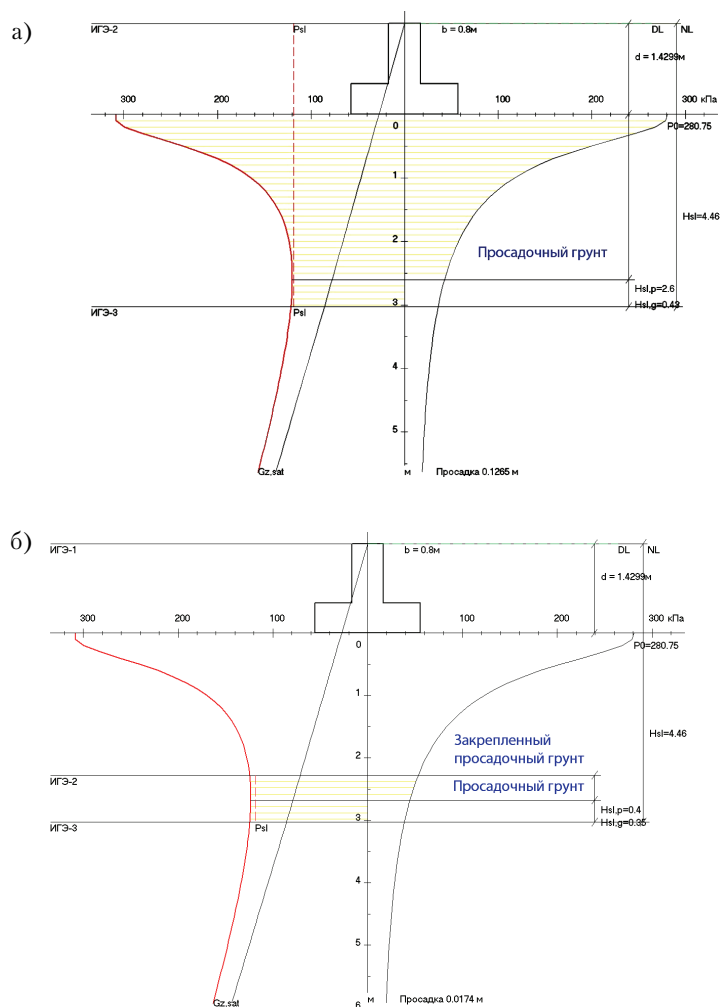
Расчетная схема для определения просадки под элементом фундамента № 3: а) без закрепления основания; б) с частичным закреплением на 75 % от просадочной толщи.
